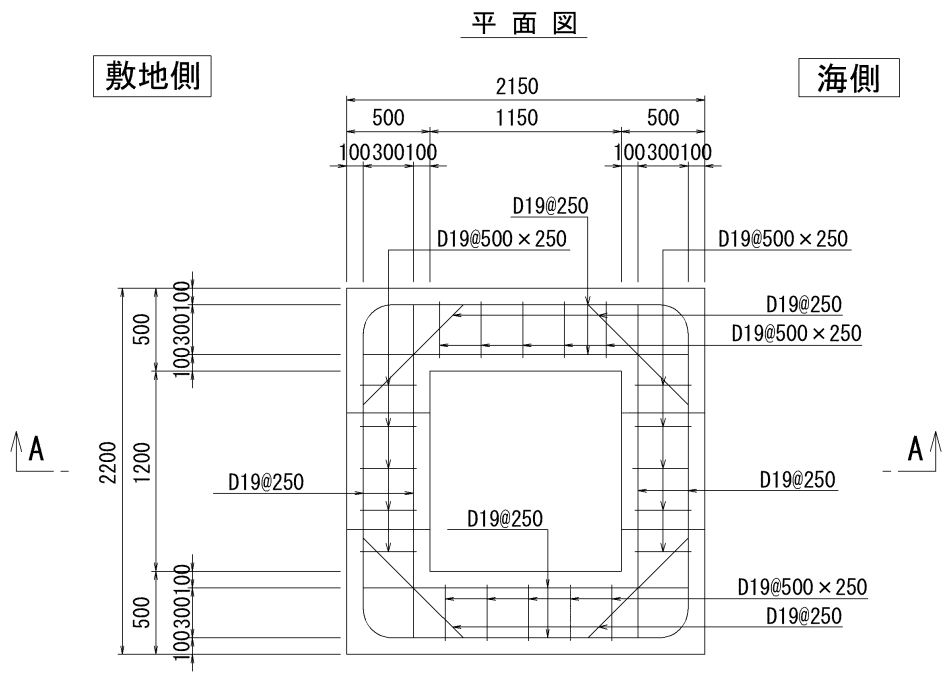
(1) 概略配筋图 (集水枱 (屋外排水路逆止弁⑦)) (单位: mm)
